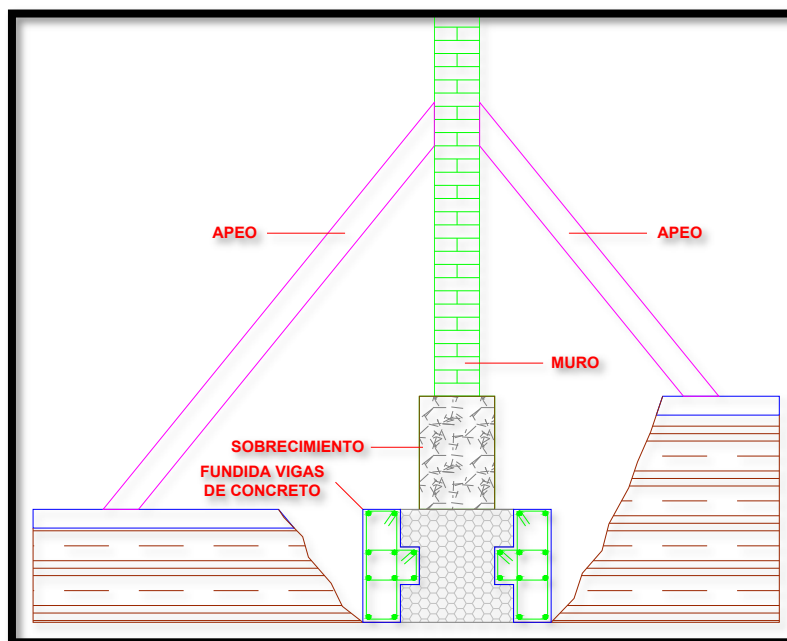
Fase 4. Armado y fundida de vigas de cimentación de sobreancho
